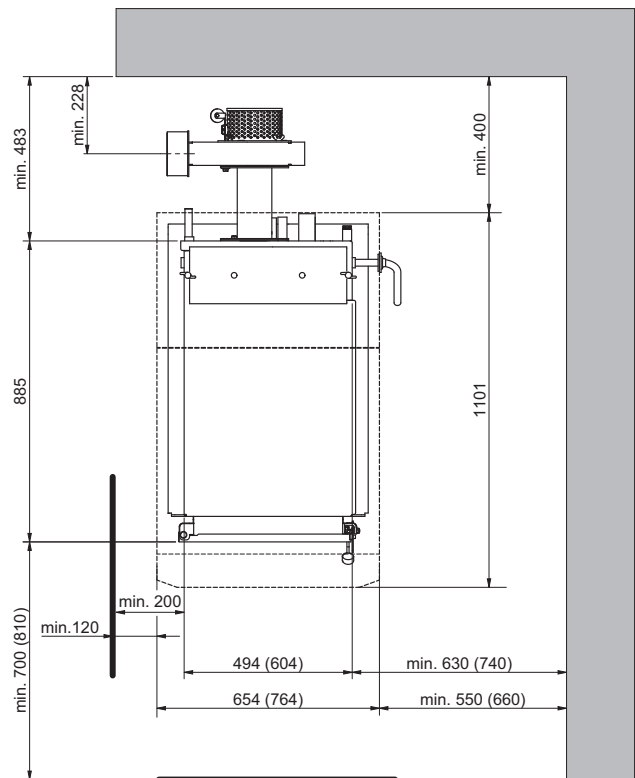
LogWIN Premium Touch mit Adapter für Abgasrohr – Ansicht von oben
